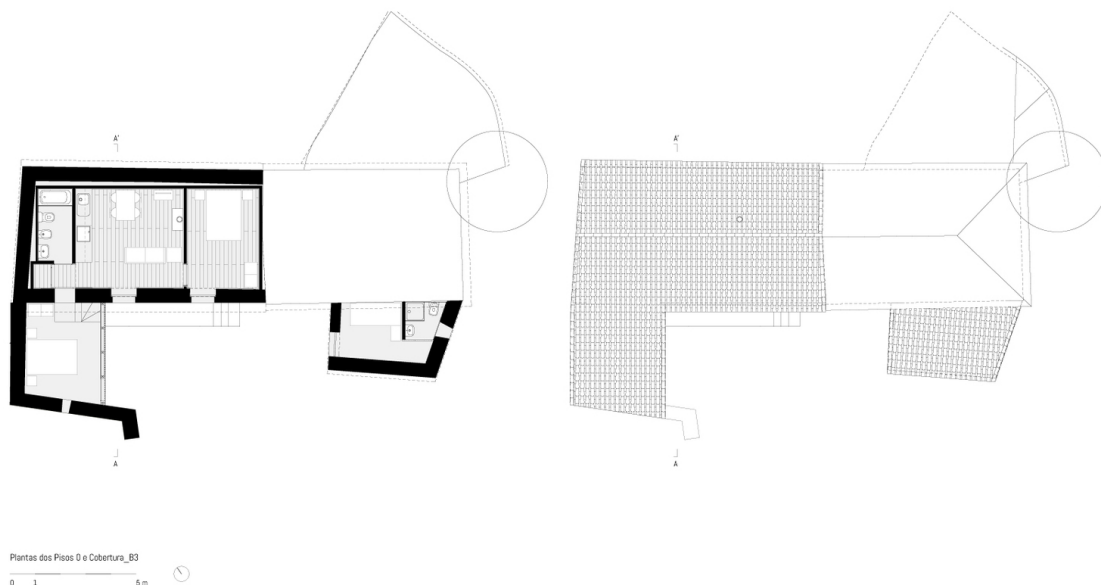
Planta do Piso 0 e Cobertura B3 - Casas do Trebilhadouro
